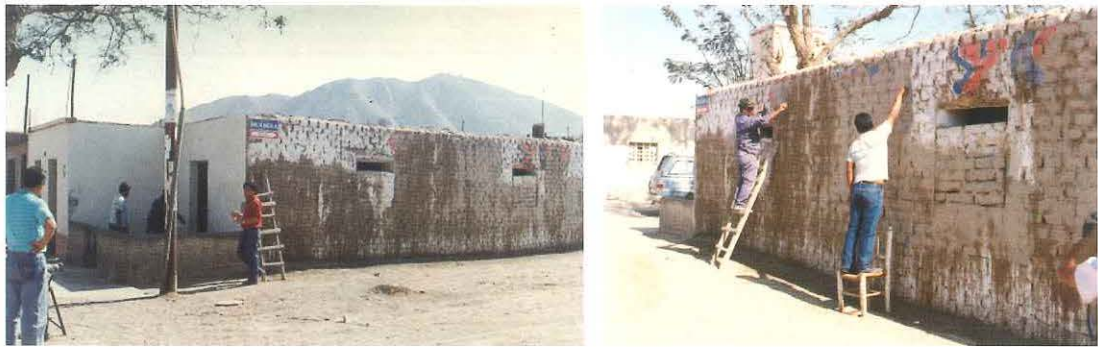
Fachada, casa de Guadalupe y trazado de una franja horizontal.
